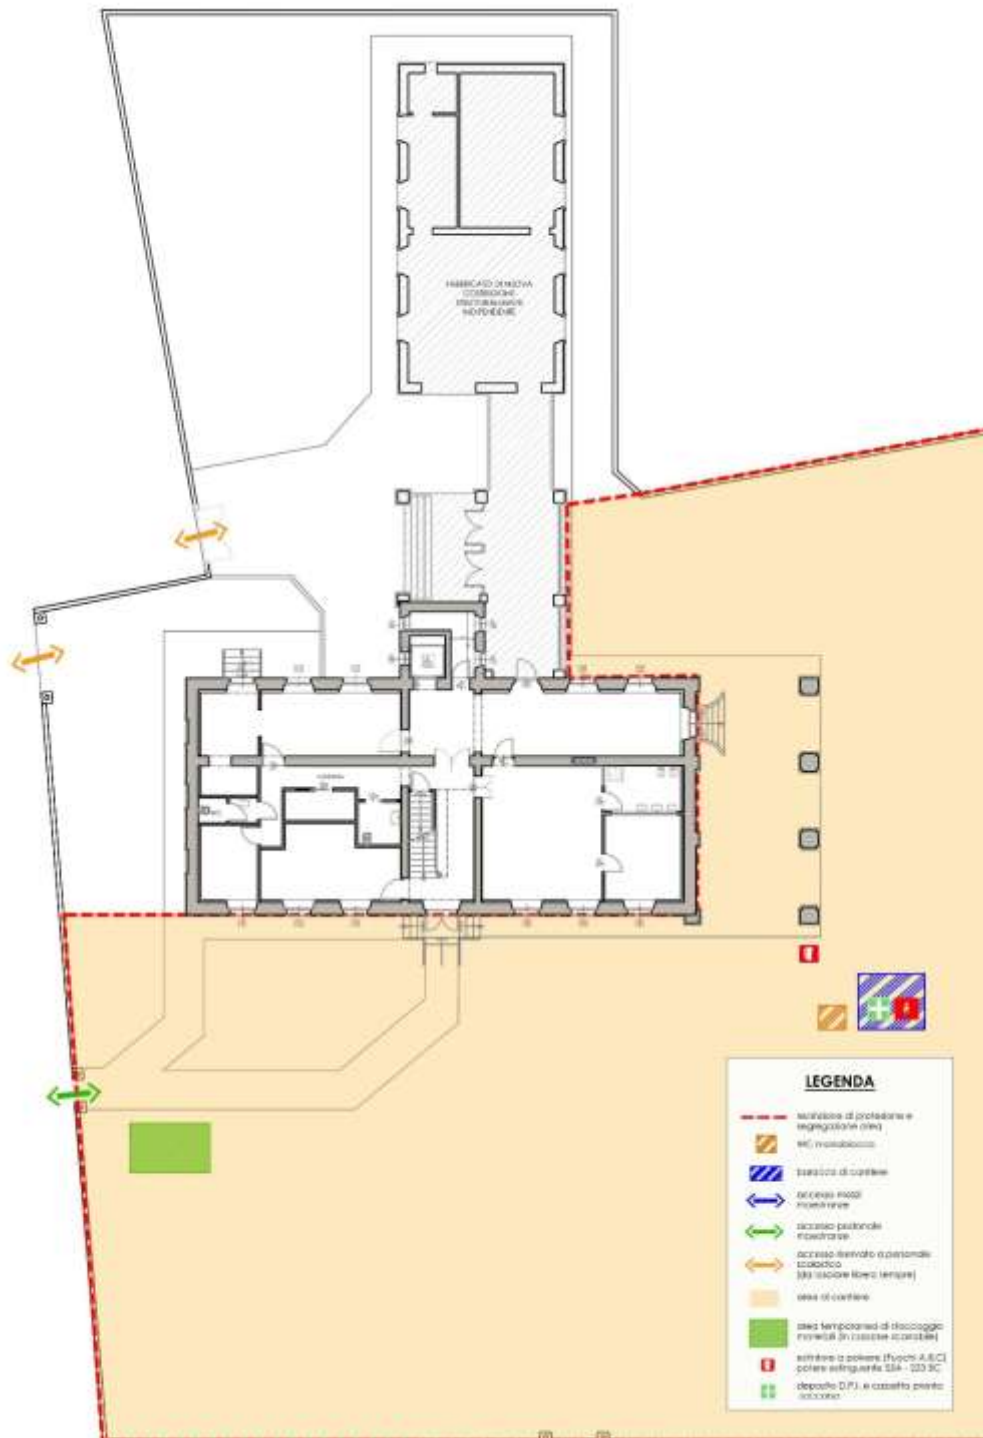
PLANIMETRIA DI CANTIERE FASE B
